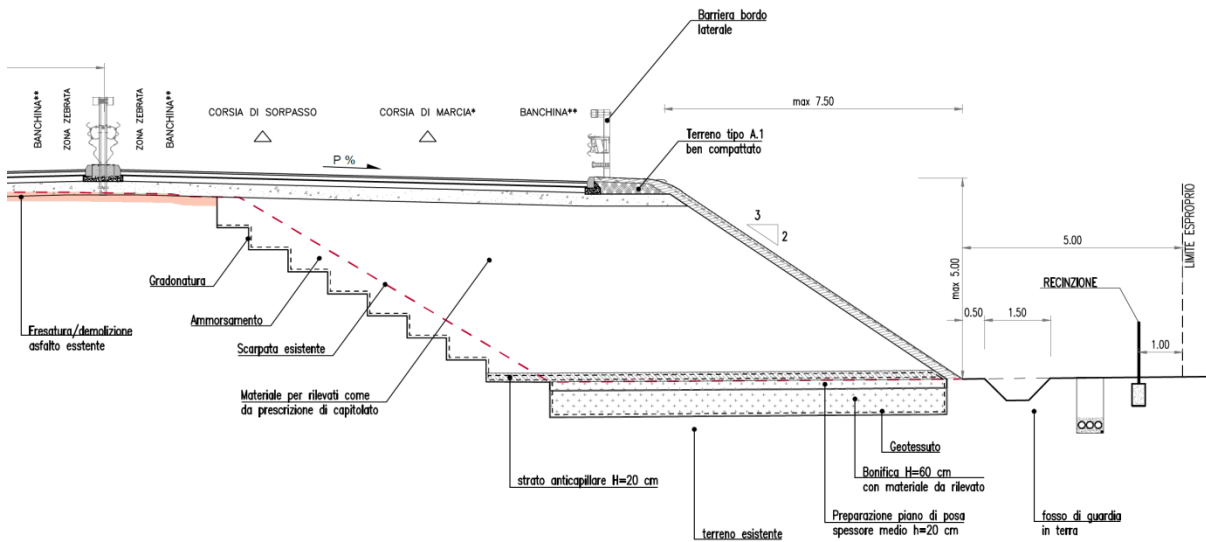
Sezione Tipo in Asse Principale in rettilineo con allargamento da un lato
